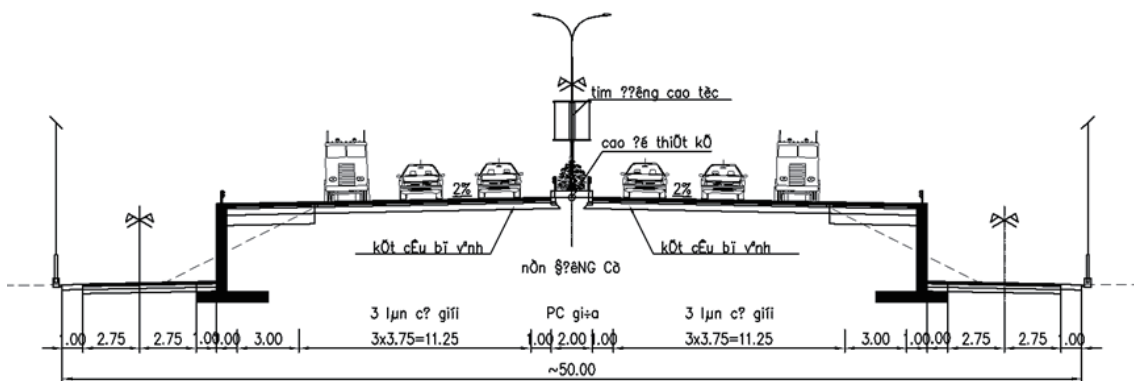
擁壁区間の標準断面図 (ROW=50 m)
